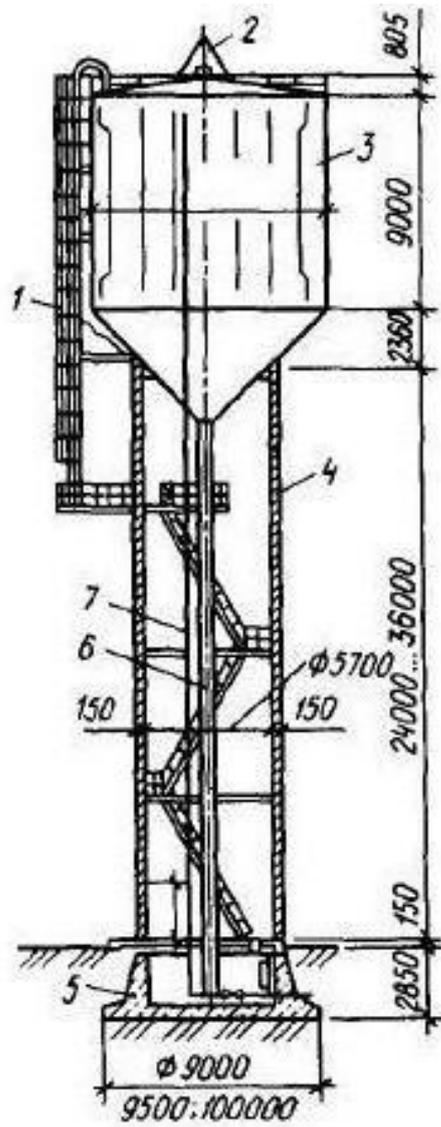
Типовая водонапорная башня с цилиндрической опорой из монолитного железобетона:
